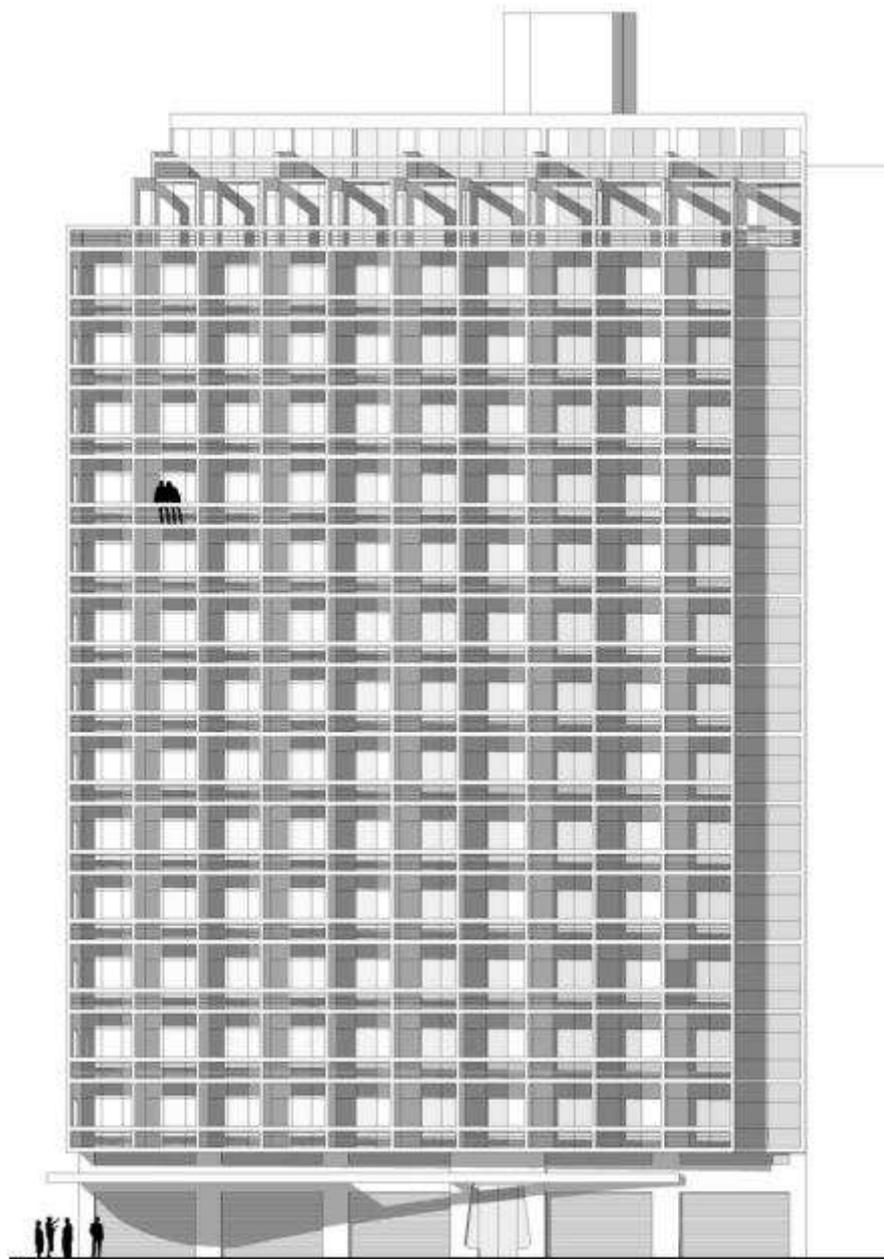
Fachada do Ed. Araraúnas (desenho do autor)
